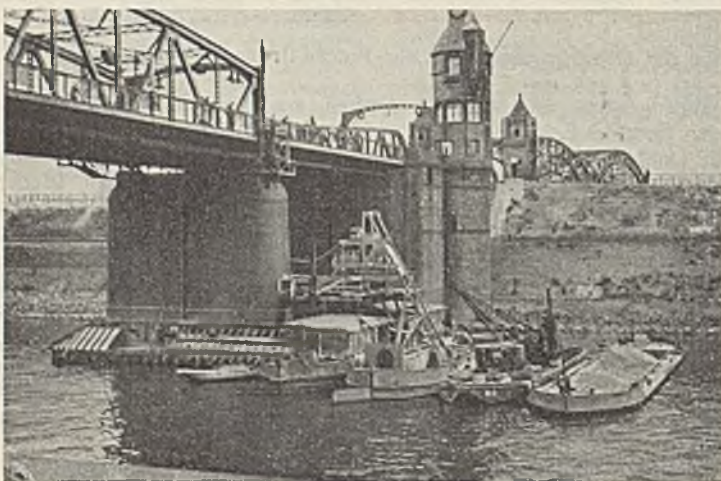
Betonierungsanlage am freistehenden Pfeiler im Hafkanal.
